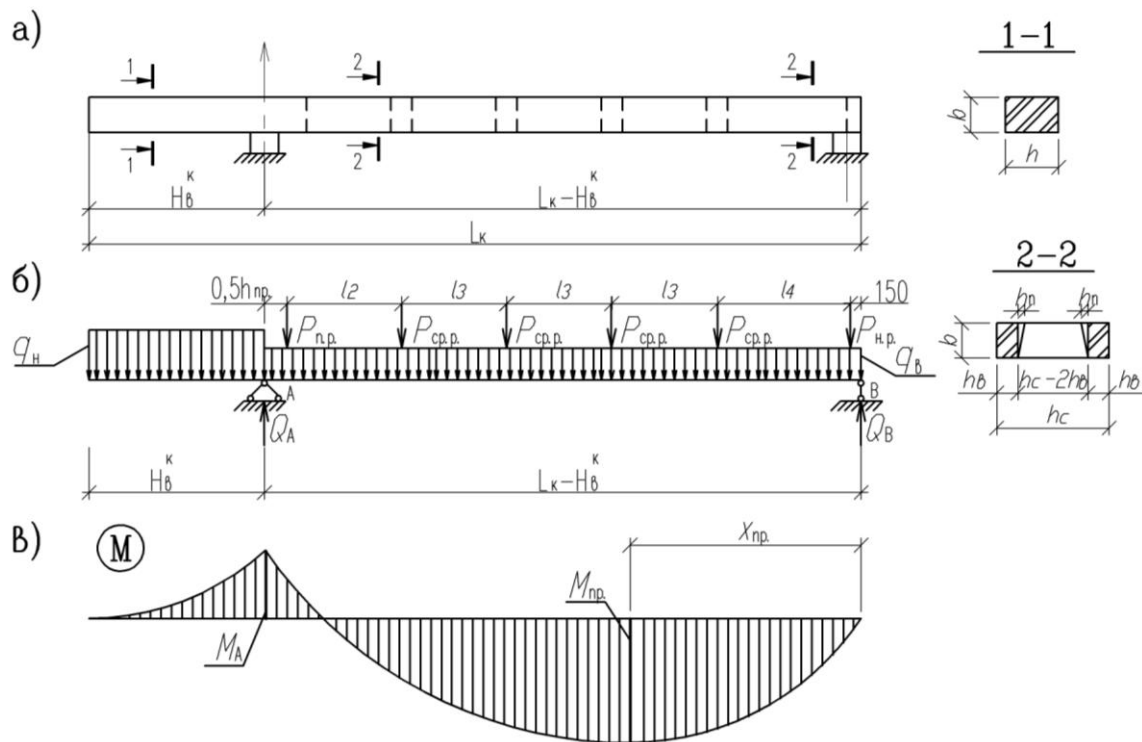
К расчету колонны в стадии монтажа в положении «плашмя»:
